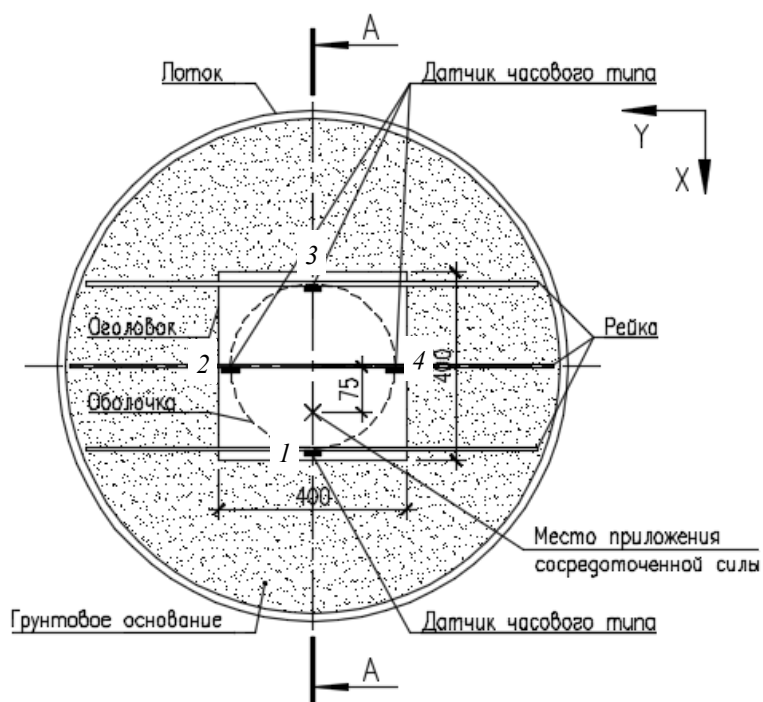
Схема экспериментальной установки (вид сверху)
